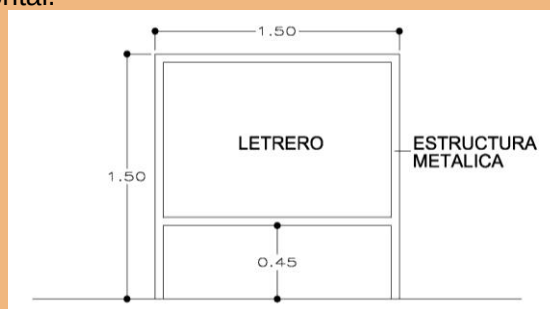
Detalle de estructura metálica para promoción de venta de lotes o casas
